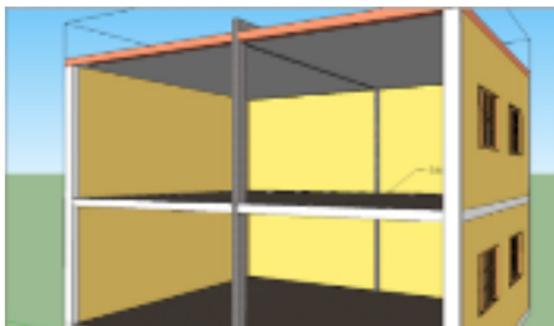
Vista geral da inserção de elementos de reabilitação com utilização de concreto de forma direta, indireta e perfil metálico pavimento superior (1960)
